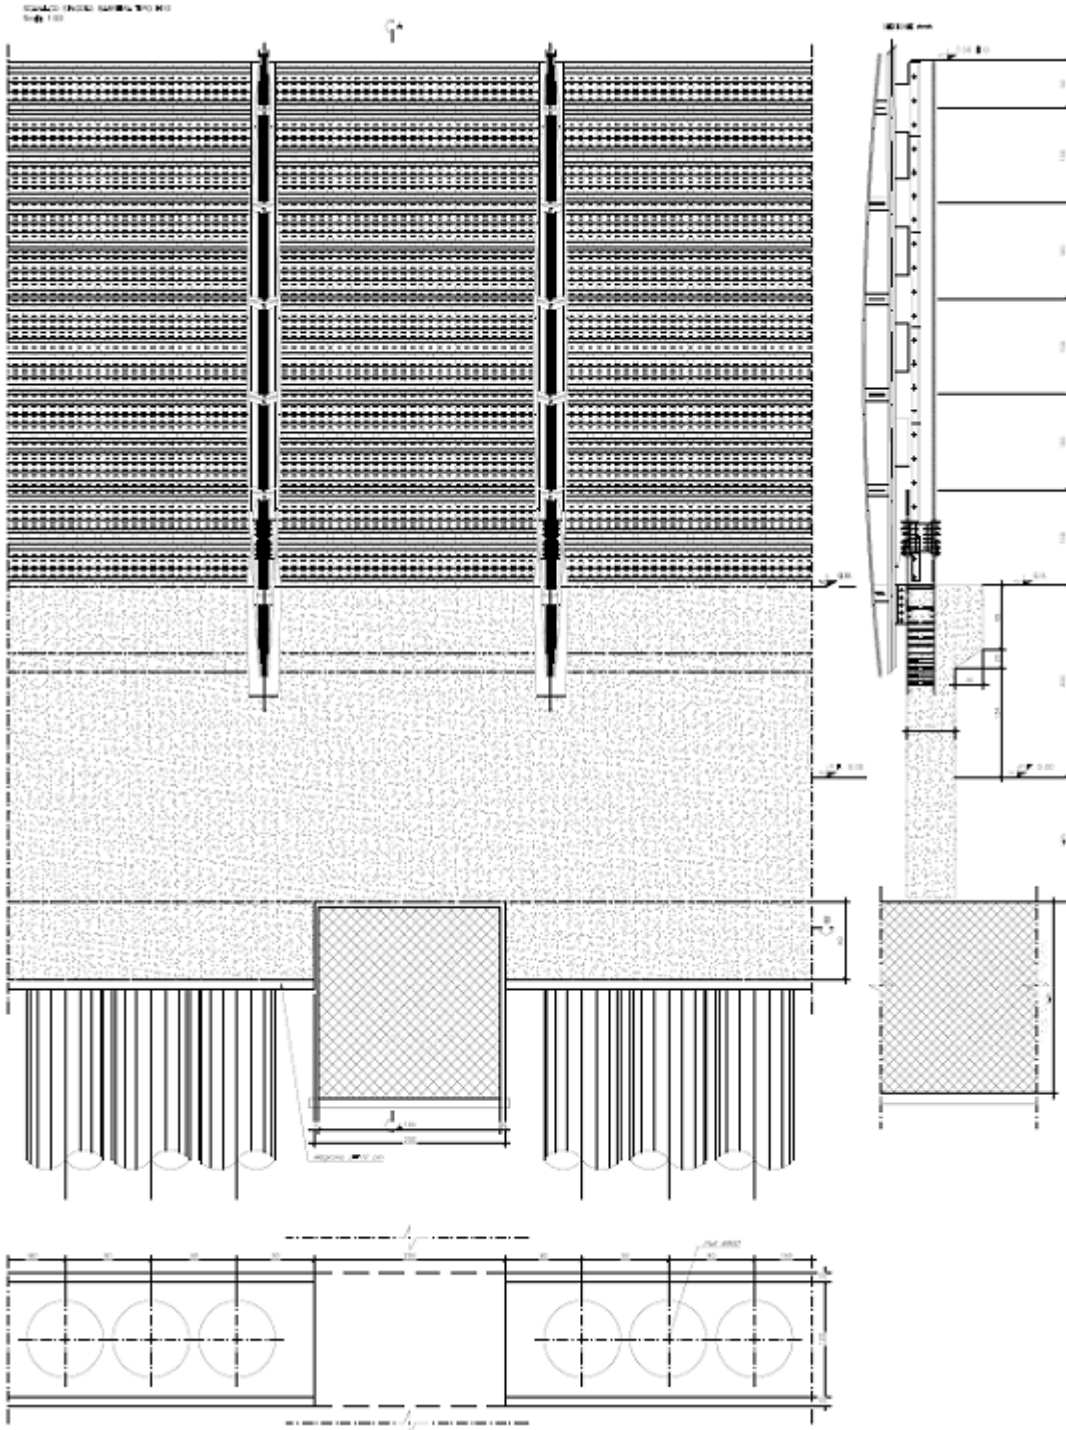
Muro di Recinzione – scavalco singolo con L=2m
